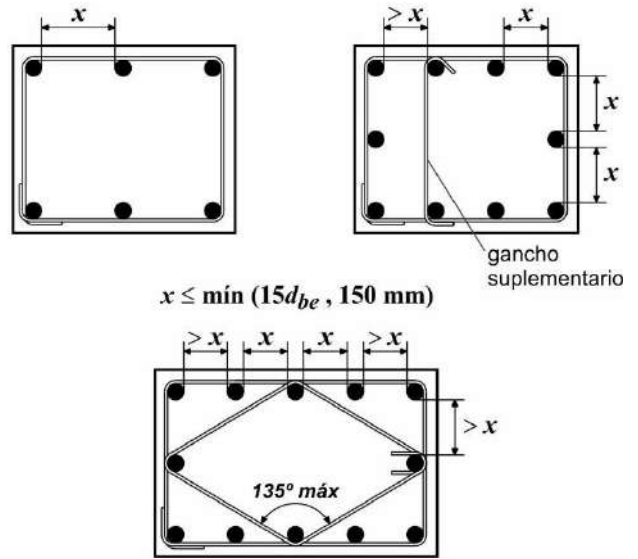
Croquis para aclarar las medidas entre barras de columna arriostradas lateralmente y el anclaje de estribos rectilíneos.
